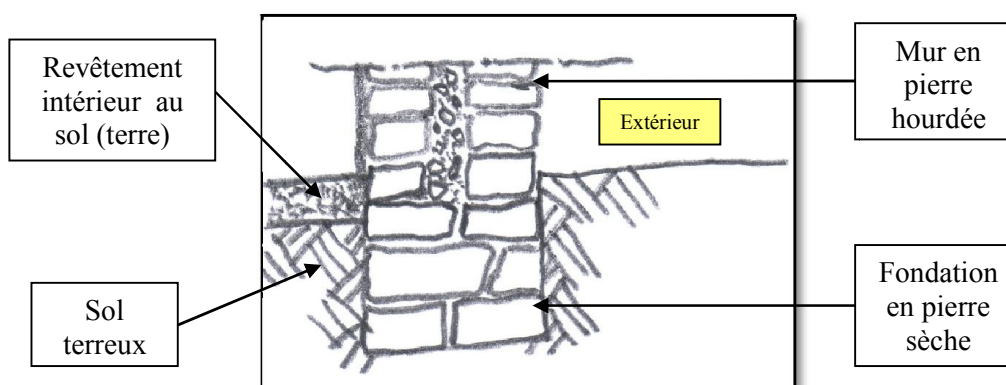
Type de fondation en pierres sèches, en tranchée superficielle.
